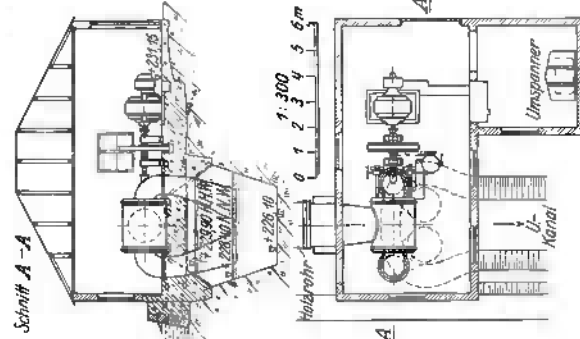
Kleinwasserkraftanlage Lindesnäs. Lageplan und Krafthauschnitt. (Vattenbyggnadsbyrå)
